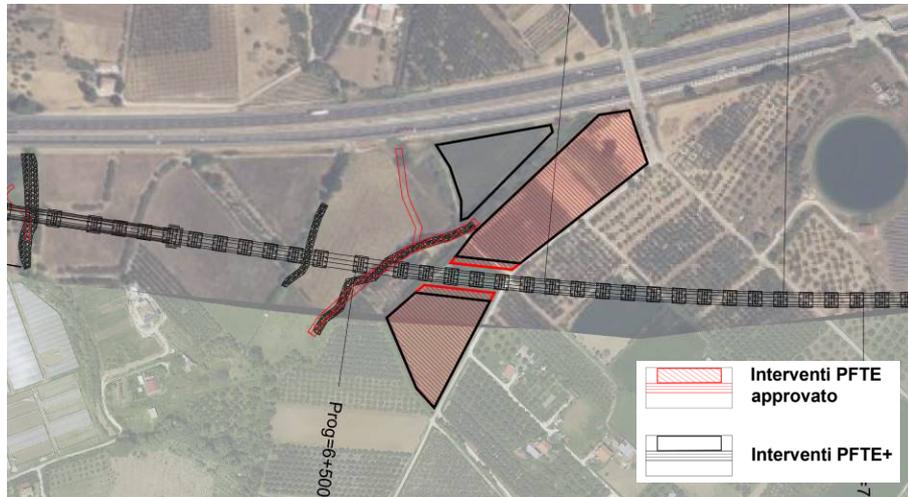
Modifiche all'area di cantiere AT.03. Sovrapposto cantieri con il sistema dei vincoli (in rosso il PFTE e in nero il PFTE+)
